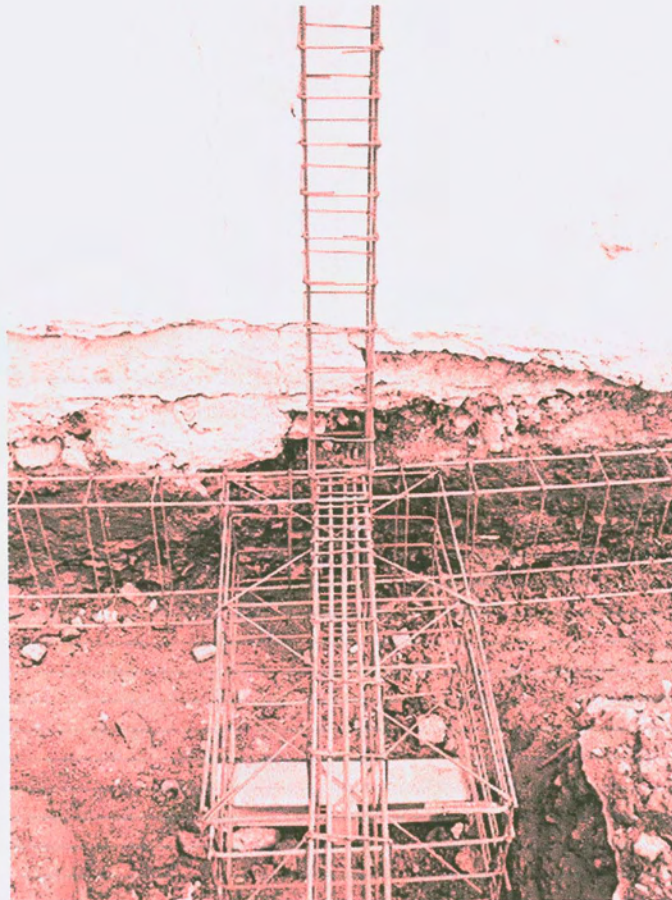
Detalhe da configuração da amarração das armações de pilar, bloco e vigas.
